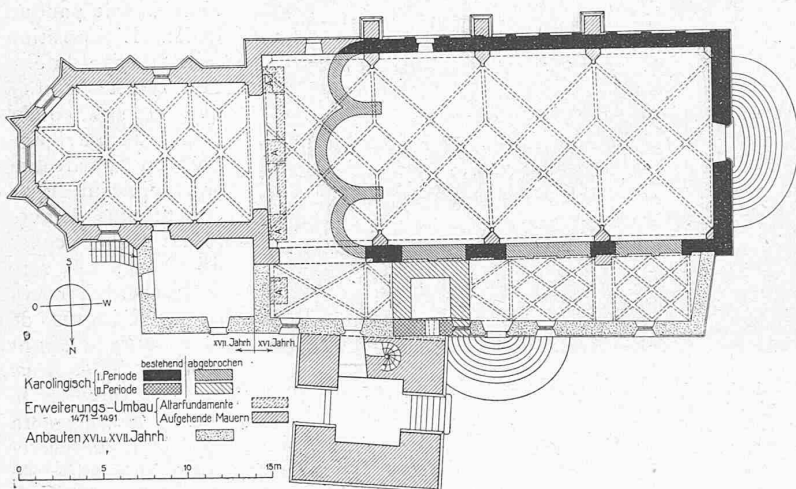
Baugeschichtlicher Grundriss der St. Martinikirche in Chur. — 1:400.
